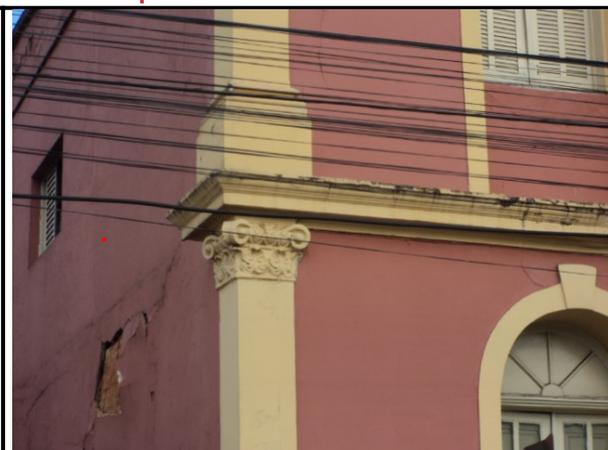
Ornamentos nos cunhais da edificação. Observar descolamento do revestimento da fachada lateral.
